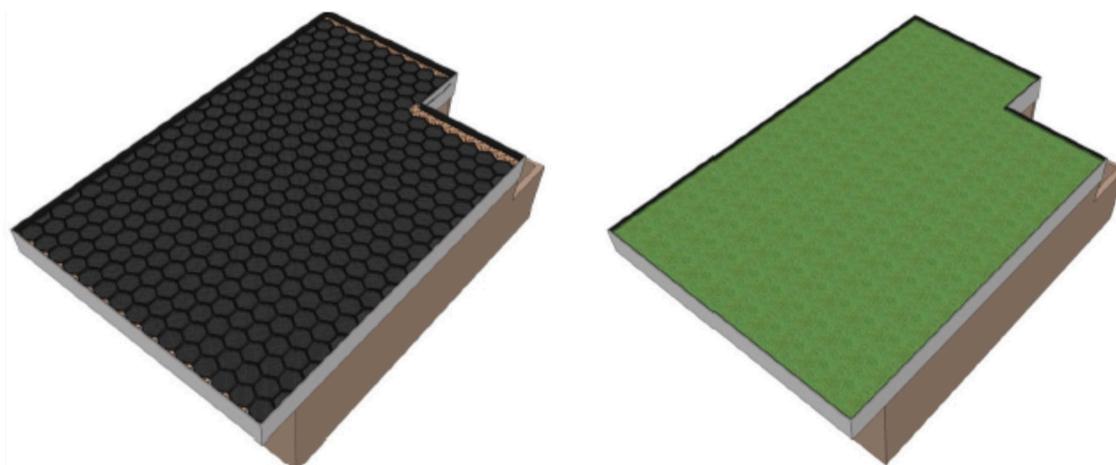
Telhado verde sistema hexa - disposição dos módulos plásticos de retenção de água e telhado verde sistema hexa vegetado.
